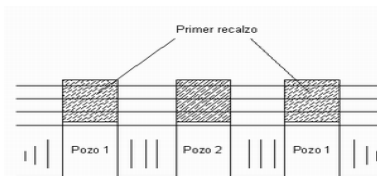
Construcción Muro Armado en pozos 1 y recalce de pozos 2.
